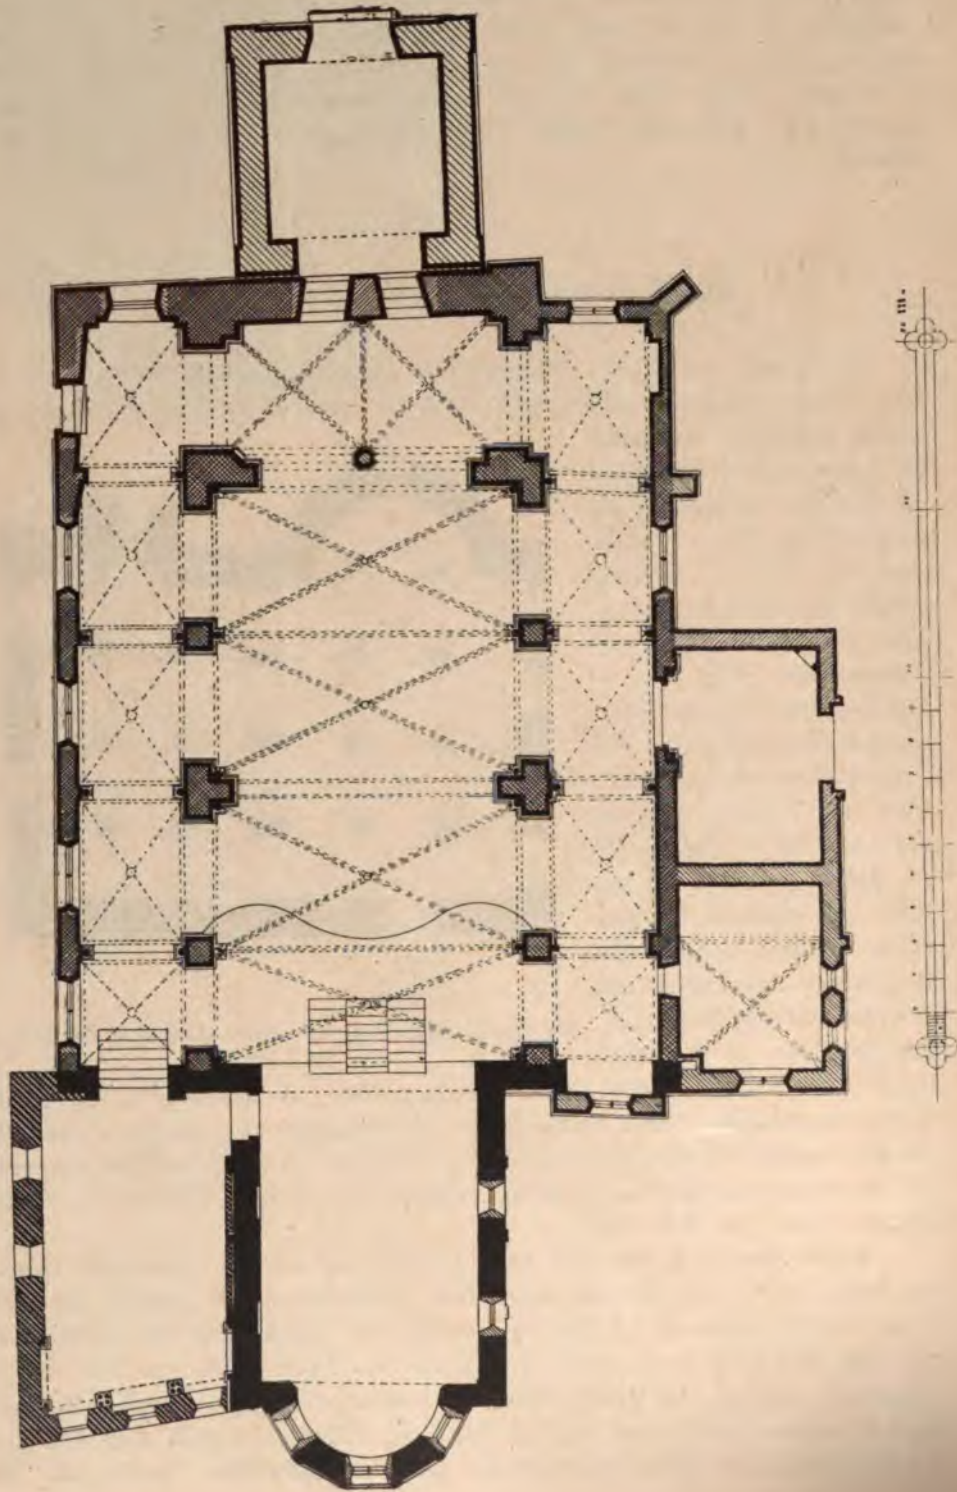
Zülpich, Propsteikirche, Grundriss vor der Wiederherstellung.
